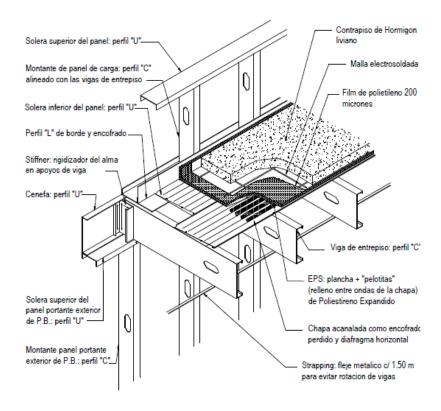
Perspectiva cubierta plana Steel Frame. Fuente: (ConsulSteel, 2014).
